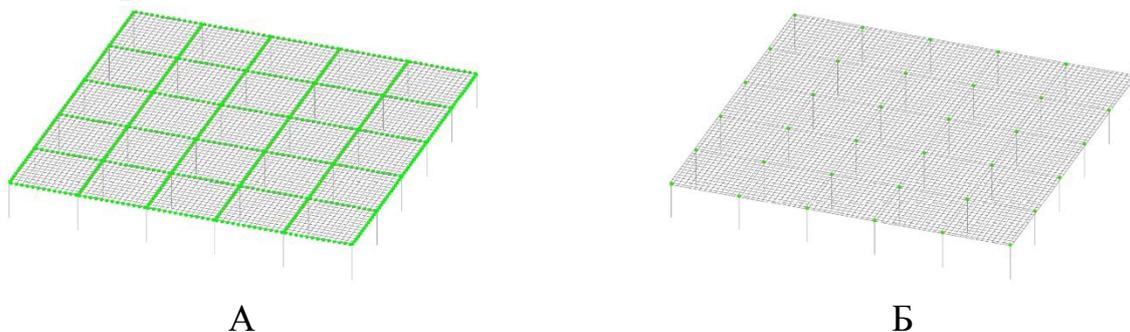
Расчетные схемы. А) схема безбалочная; Б) схема с условными балками
